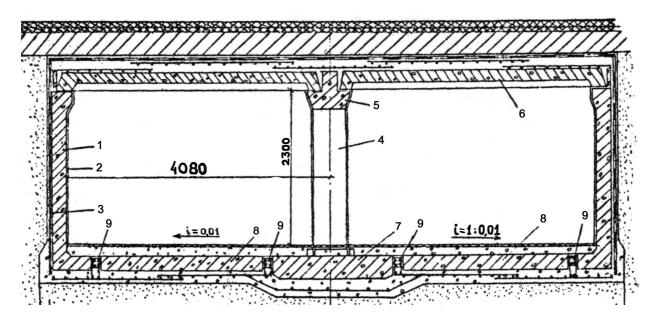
Сечение 1-1. 1 – стеновый блок; 2 – керамическая облицовочная плитка; 3 – гидроизоляция; 4 – стойка; 5 – ригель; 6 – плиты перекрытия; 7 – плиты днища; 9 – участок омоноличивания
